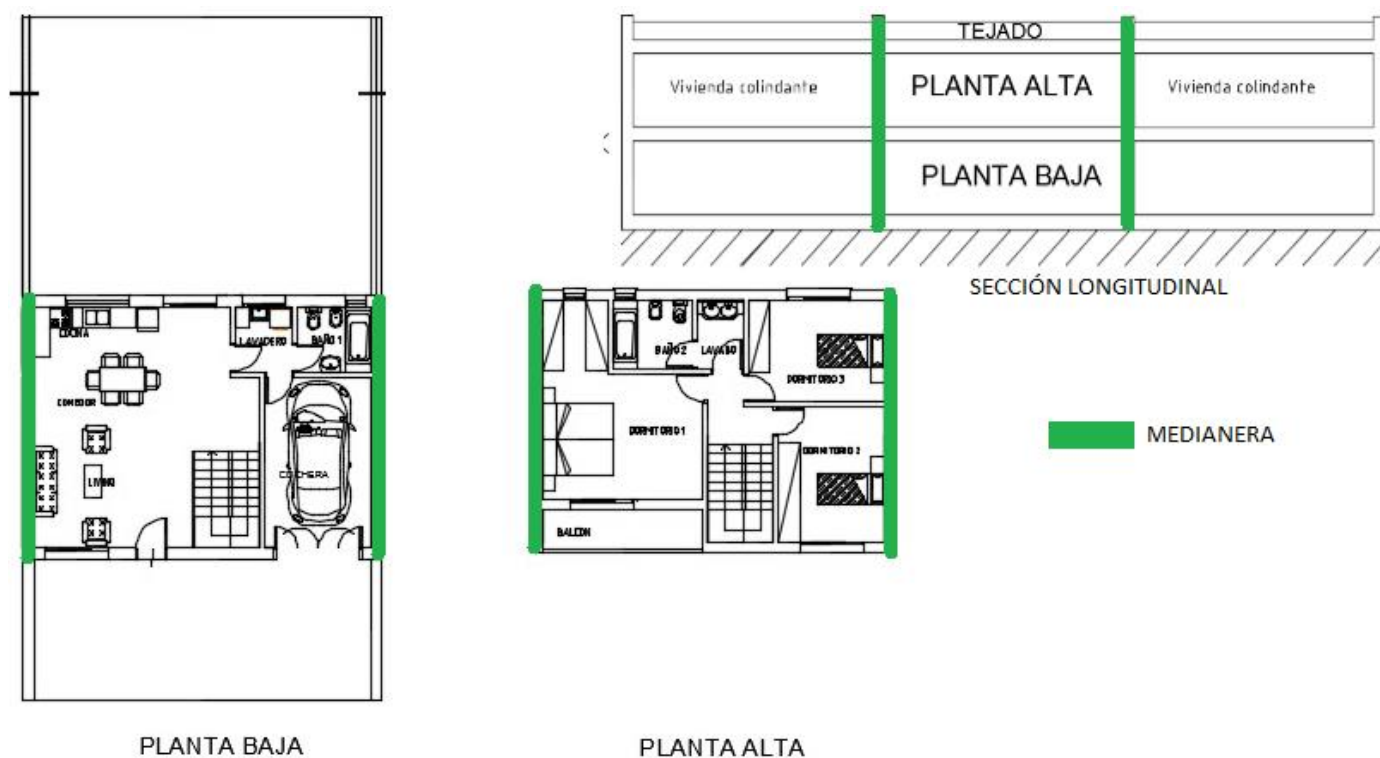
Cerramiento fachada en planta baja, planta alta y sección longitudinal.
